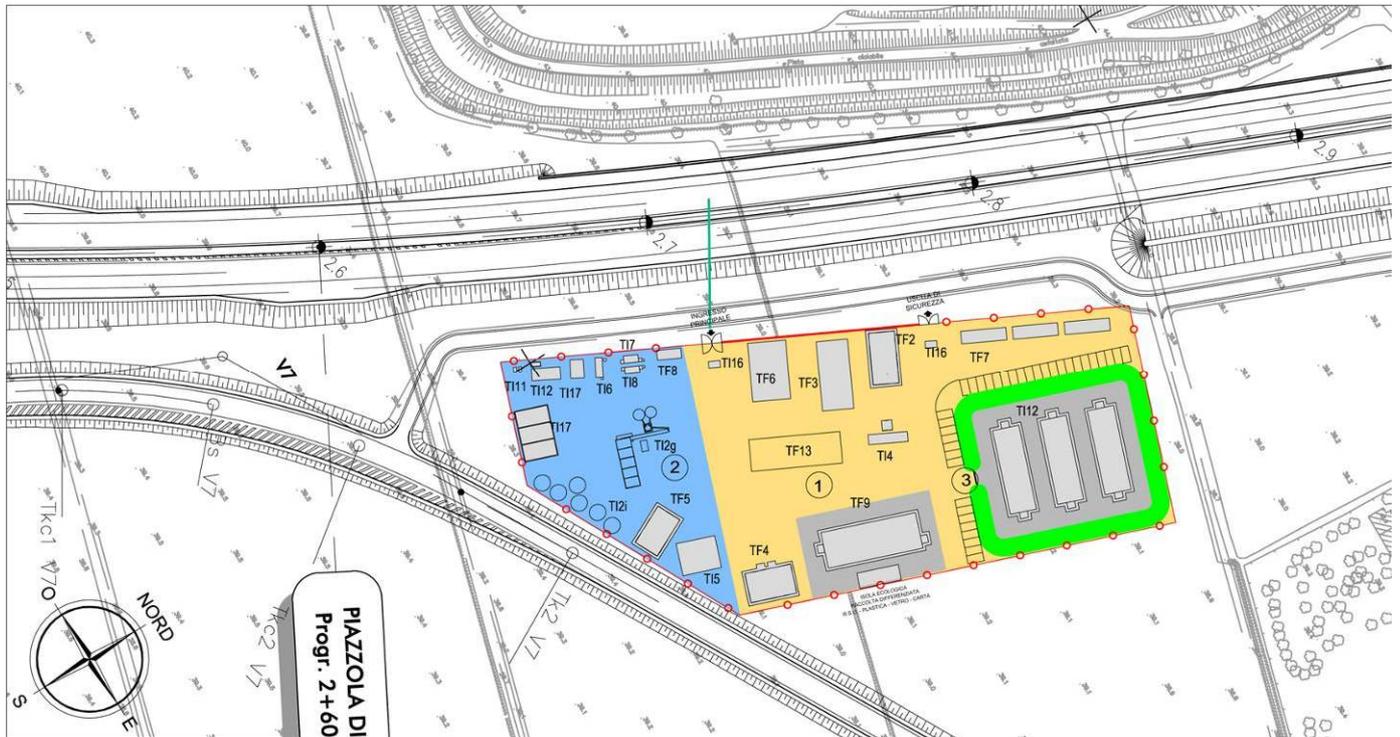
Planimetria del cantiere PV del Progetto Definitivo e relativa legenda.
